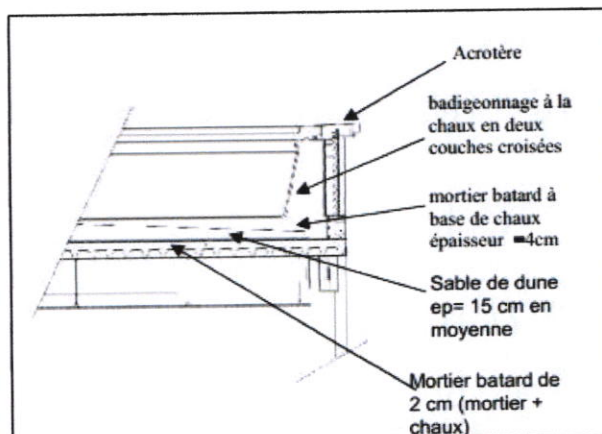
détail toiture terrasse (1/20) source : auteurs 2018.
